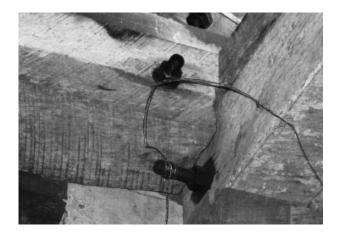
Detalle de la colocación de viguetas o purlings en el caballete de la cubierta.
